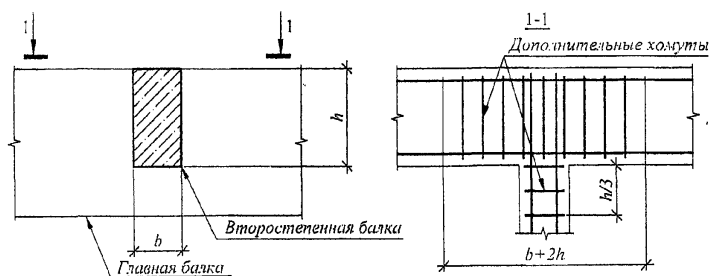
Размещение опорной арматуры в зоне пересечения двух балок
